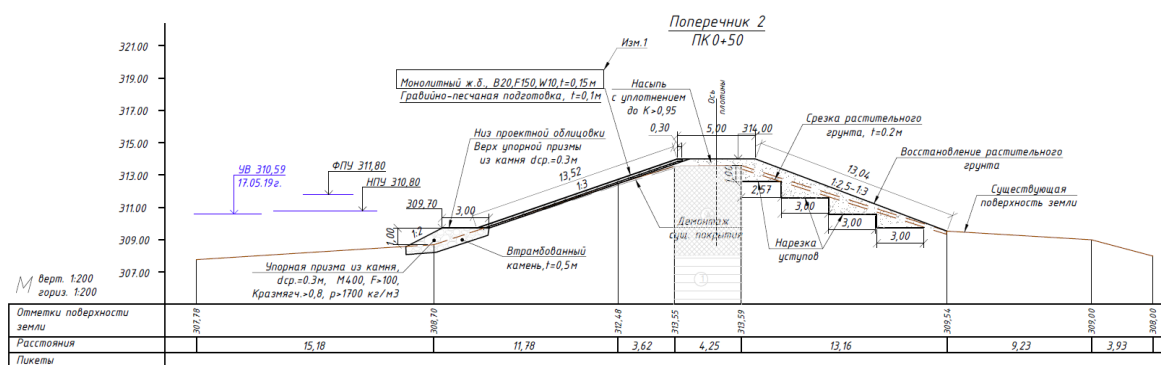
Поперечное профиль грунтовой плотины в наиболее опасном сечении.
